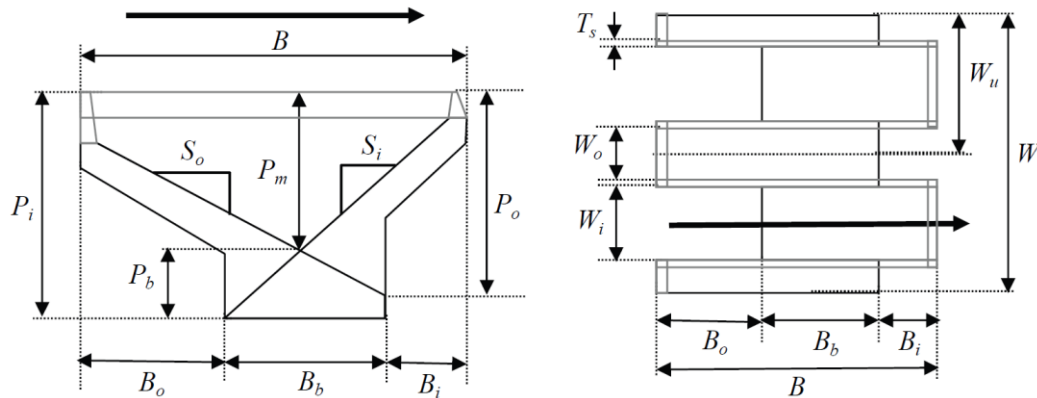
Parámetros PKW – Vista transversal y vista en planta
